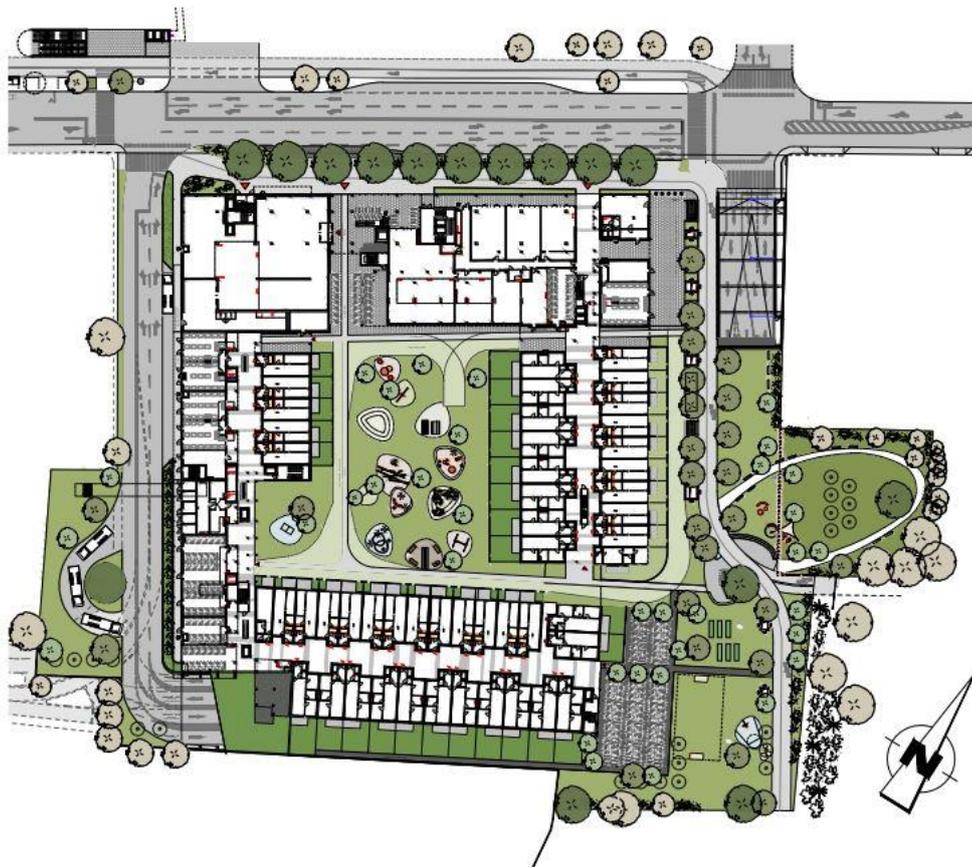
Übersichtslageplan der geplanten städtebaulichen Überbauung
